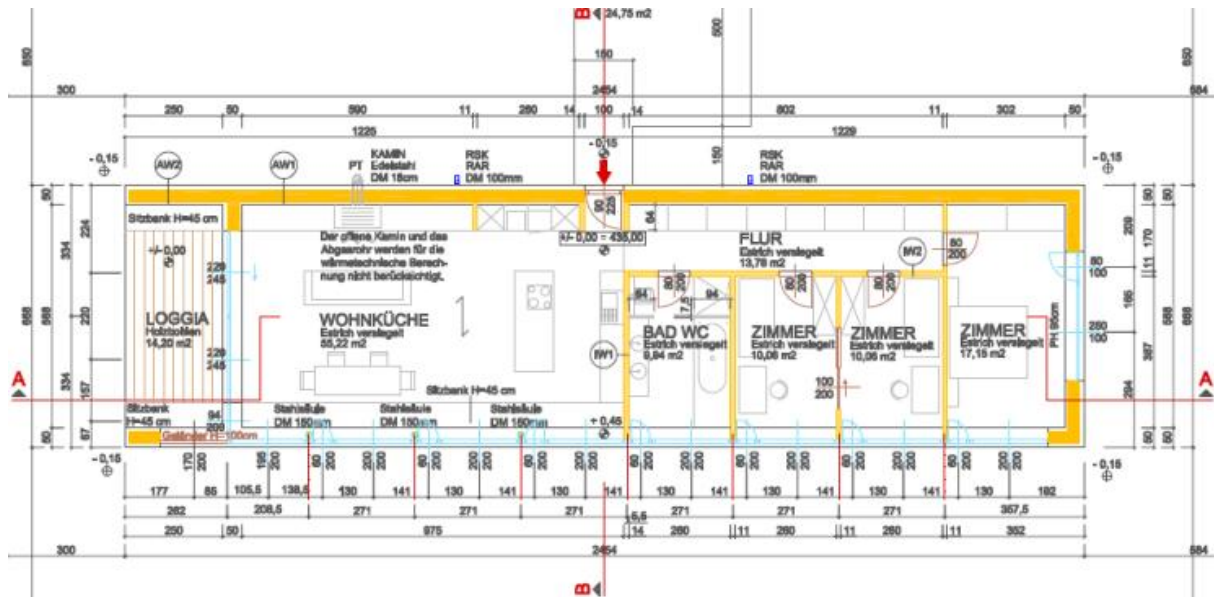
Grundriss Modellgebäude in Leichtbauweise (Riegelwandkonstruktion)
